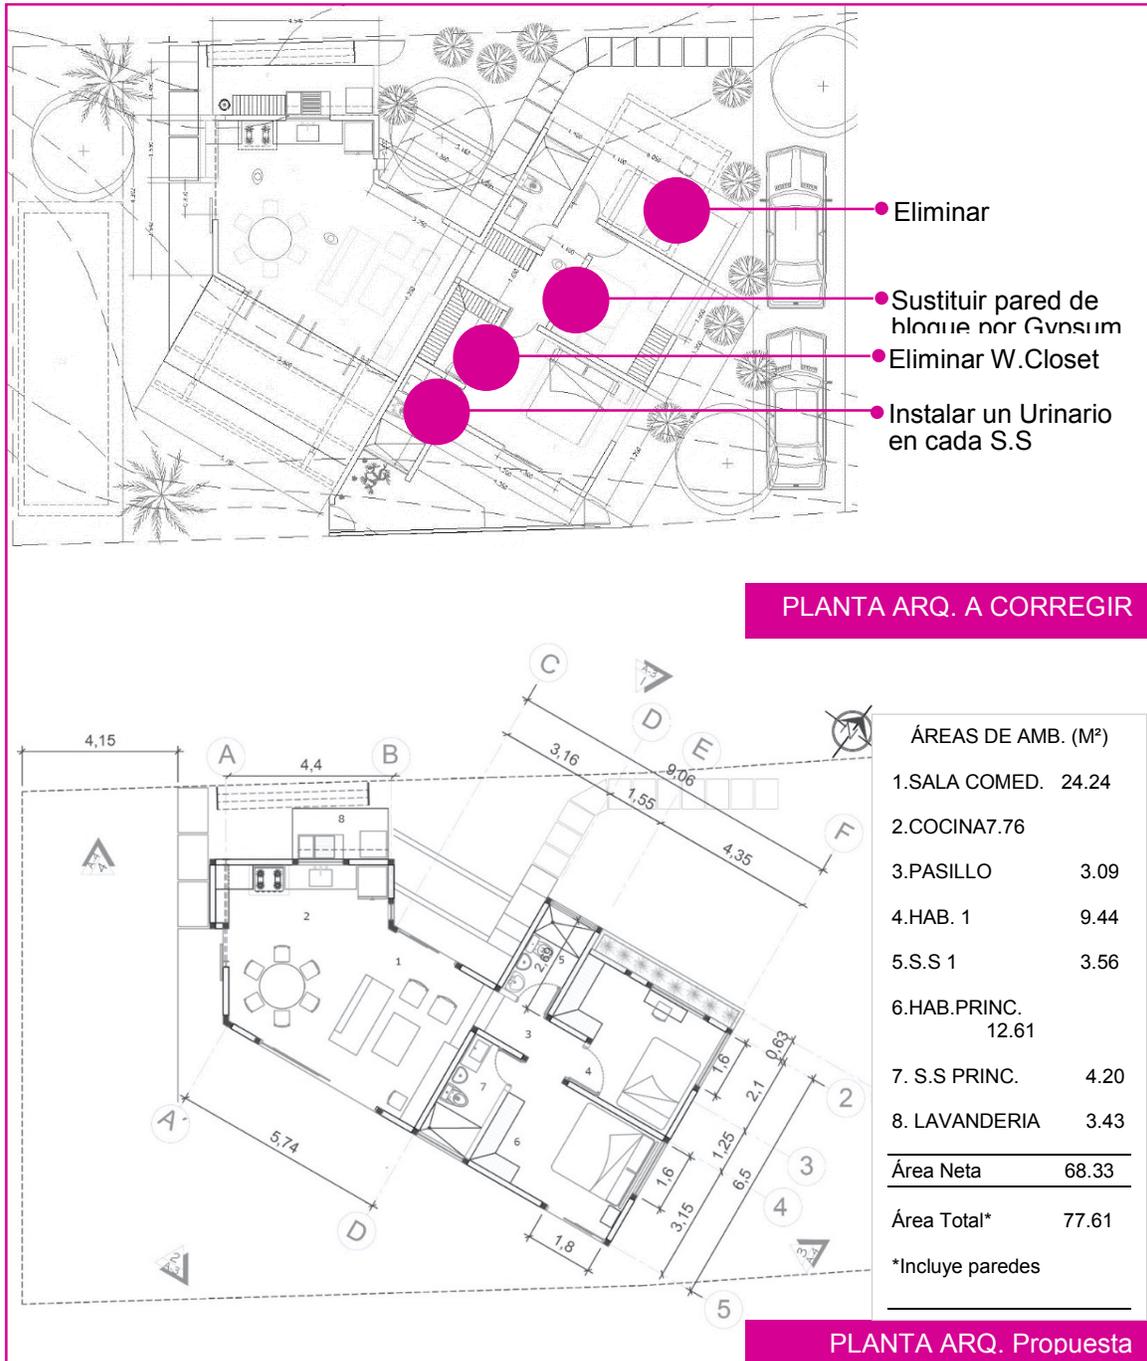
Planta Arquitectónica suministrada por el cliente, Planta Propuesta. Fuente: Autor. Programa Autocad.
